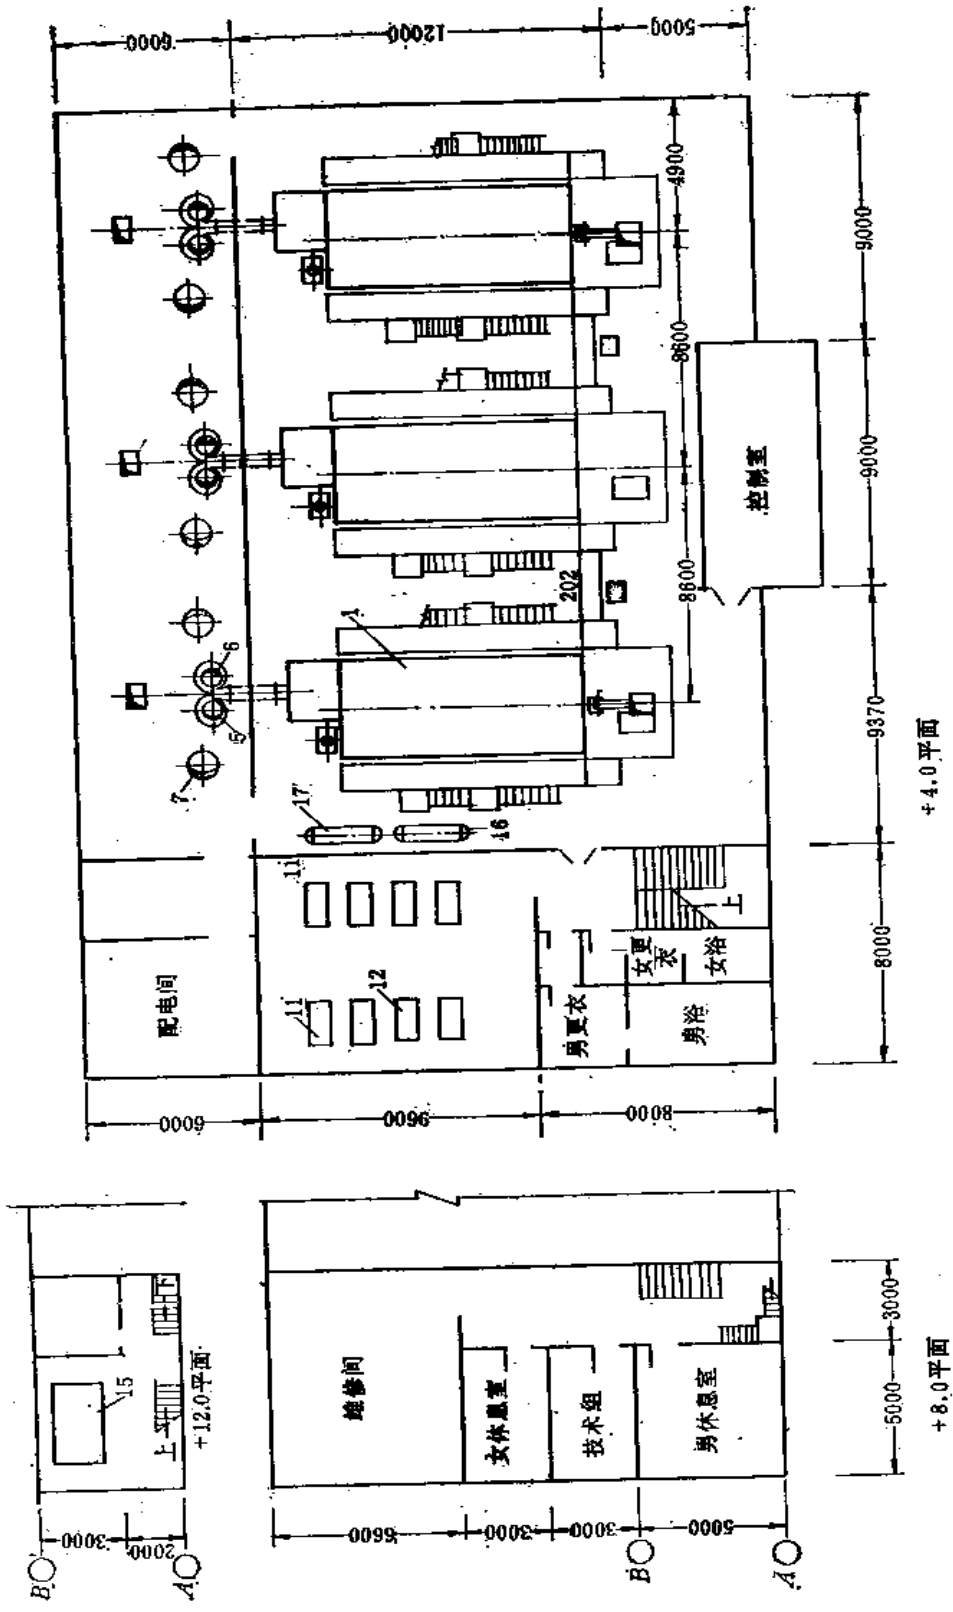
三台SHF6.5-13型锅炉房楼层平面图
